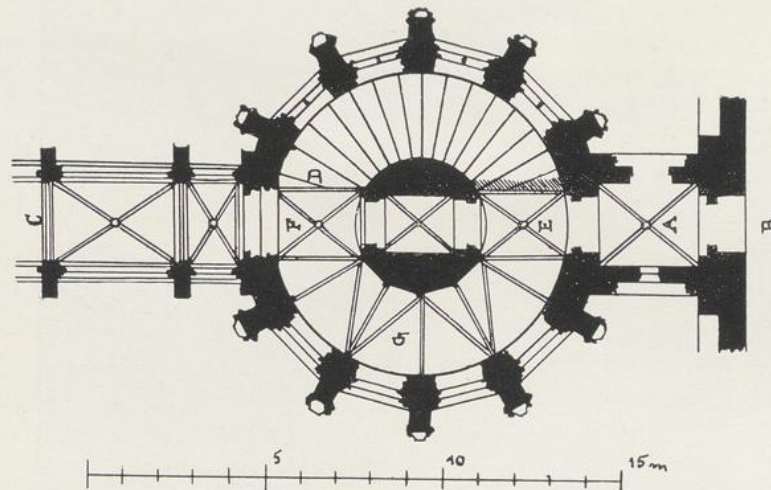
b. Treppe aus dem Louvre zu Paris. Grundriß.
